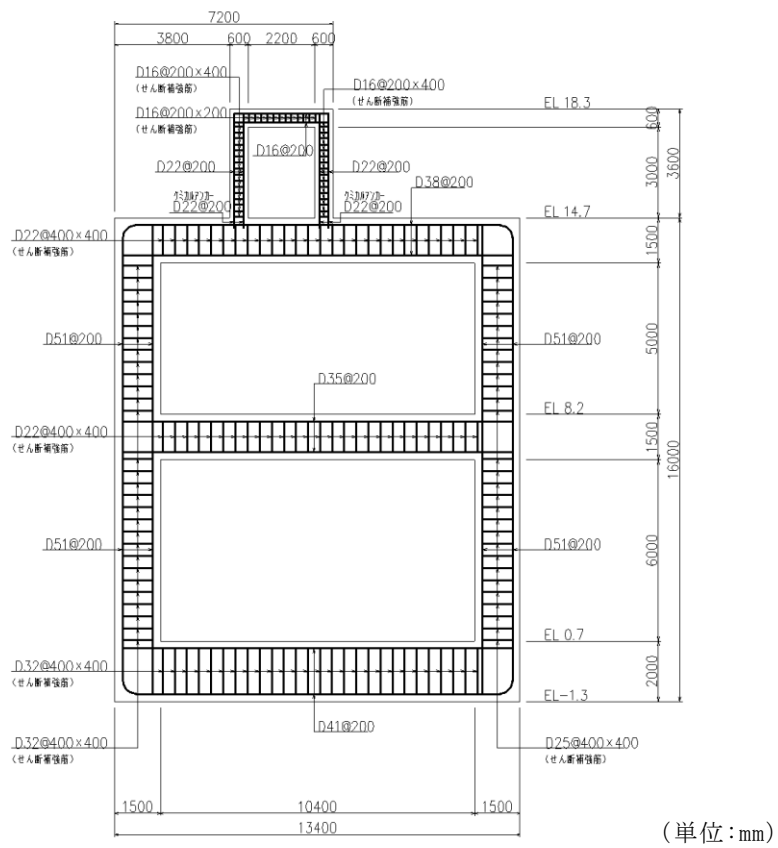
低圧原子炉代替注水ポンプ格納槽 概略配筋図 (A-A 断面)
